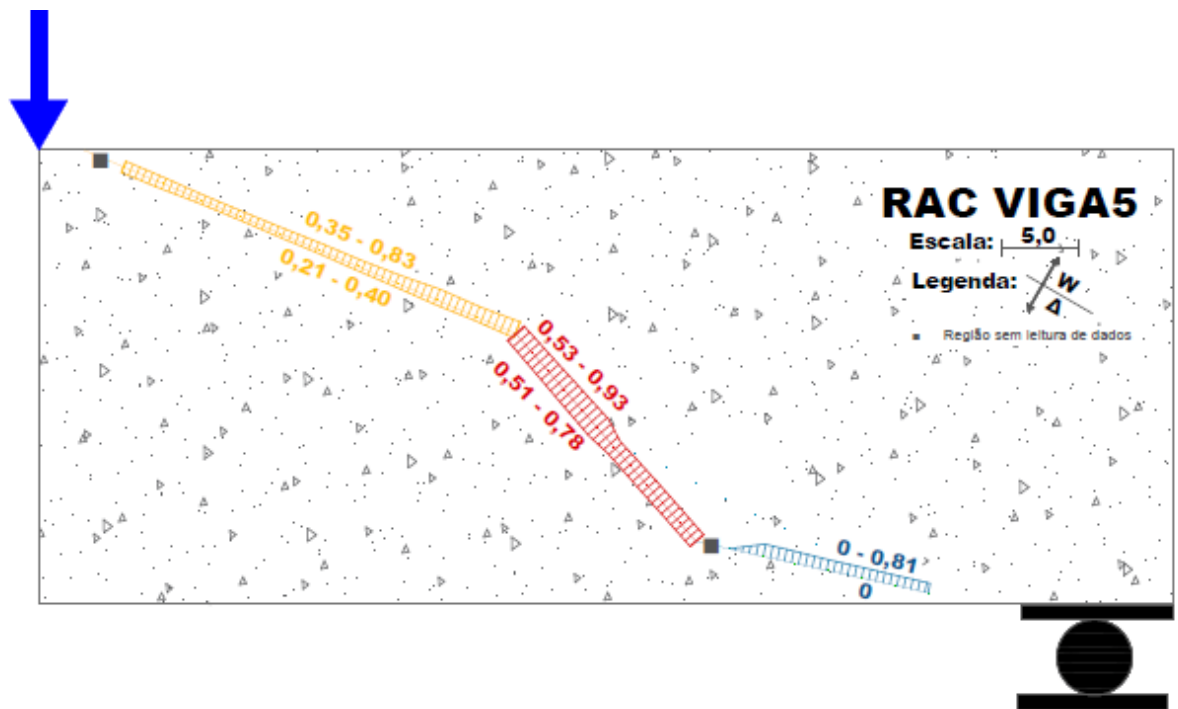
Abertura (w) e deslizamento (Δ) da fissura diagonal crítica da viga RAC-5.
